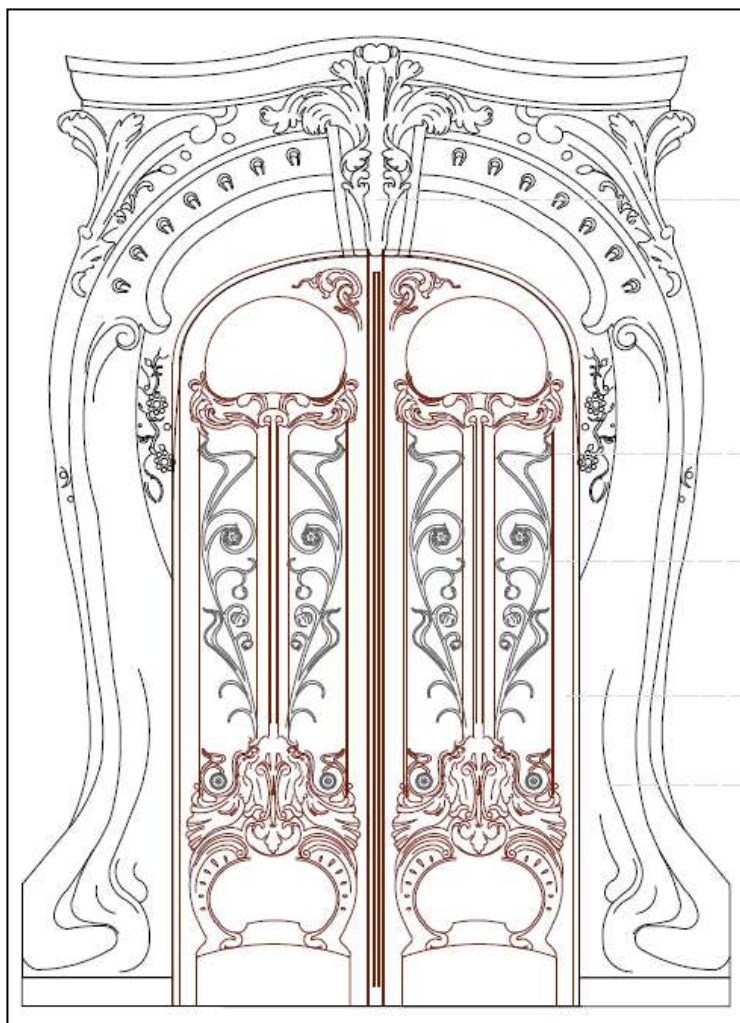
b. Portail de la façade N59/61. Style Art Nouveau.
